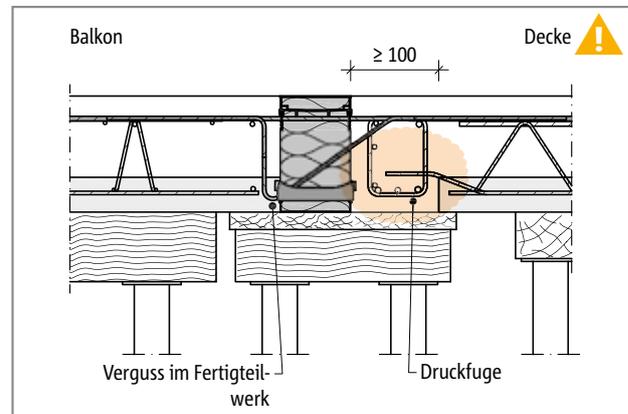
Schöck Isokorb® Typ KXT: Indirekte Lagerung, Einbau in Verbindung mit Elementplatten (hier: $h \leq 200$ mm), Druckfuge deckenseitig
